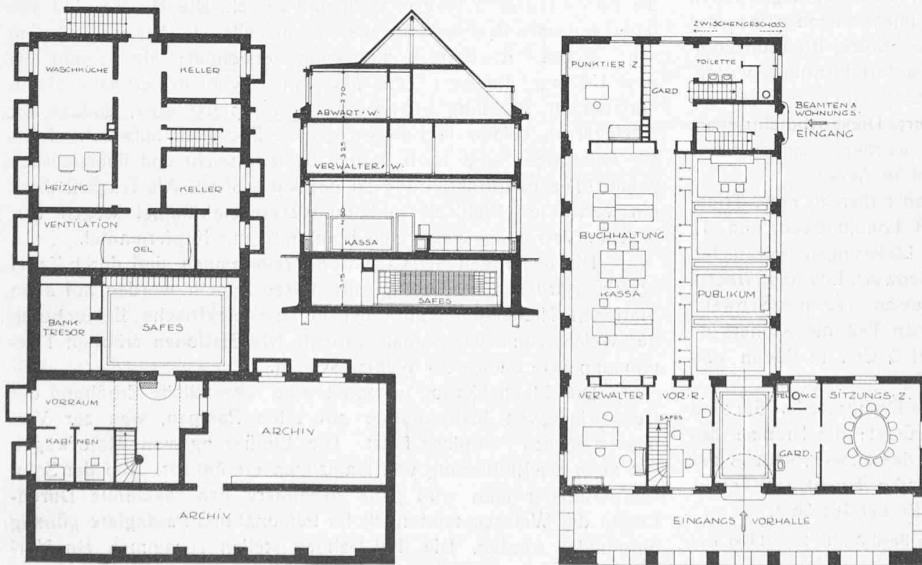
bis 8. Keller- und Erdgeschoss-Grundriss und Schnitt. — Masstab 1 : 400.
